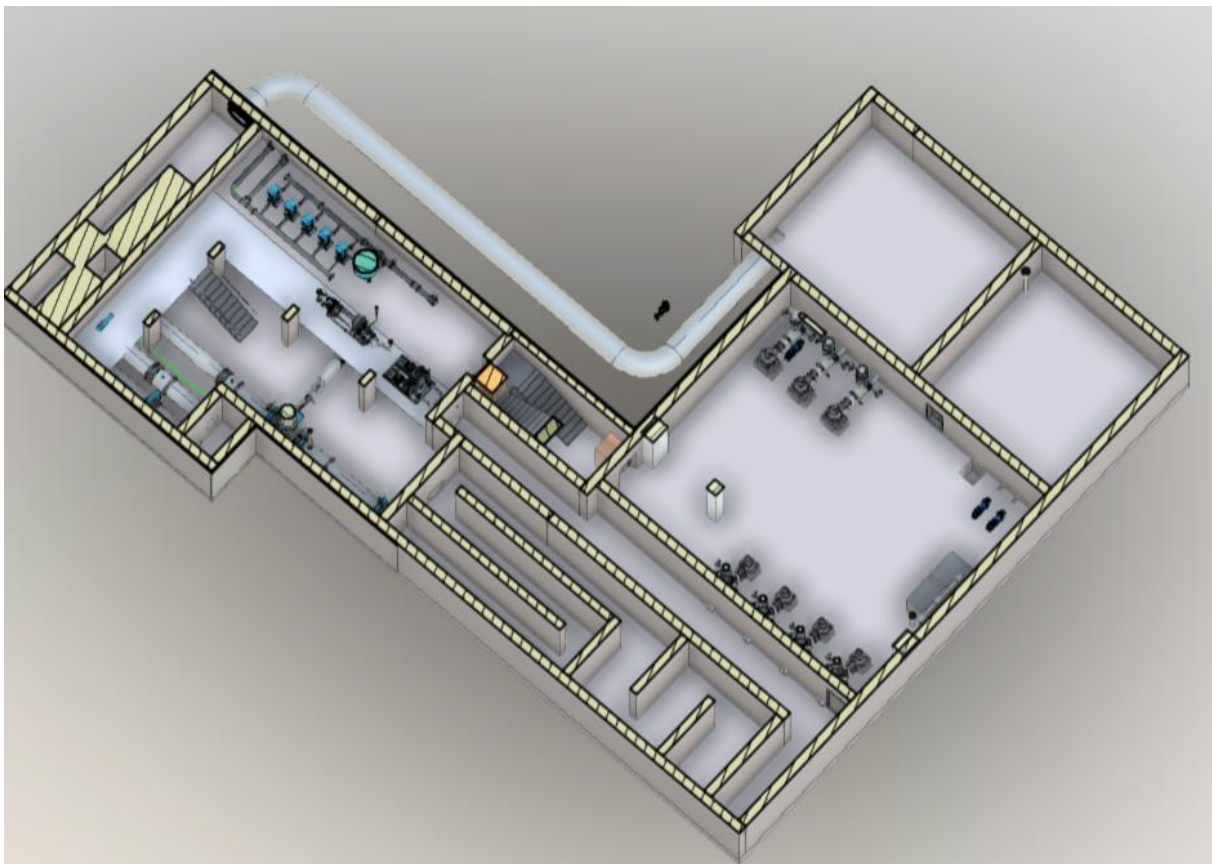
Grundriss 4. Reinigungsstufe
